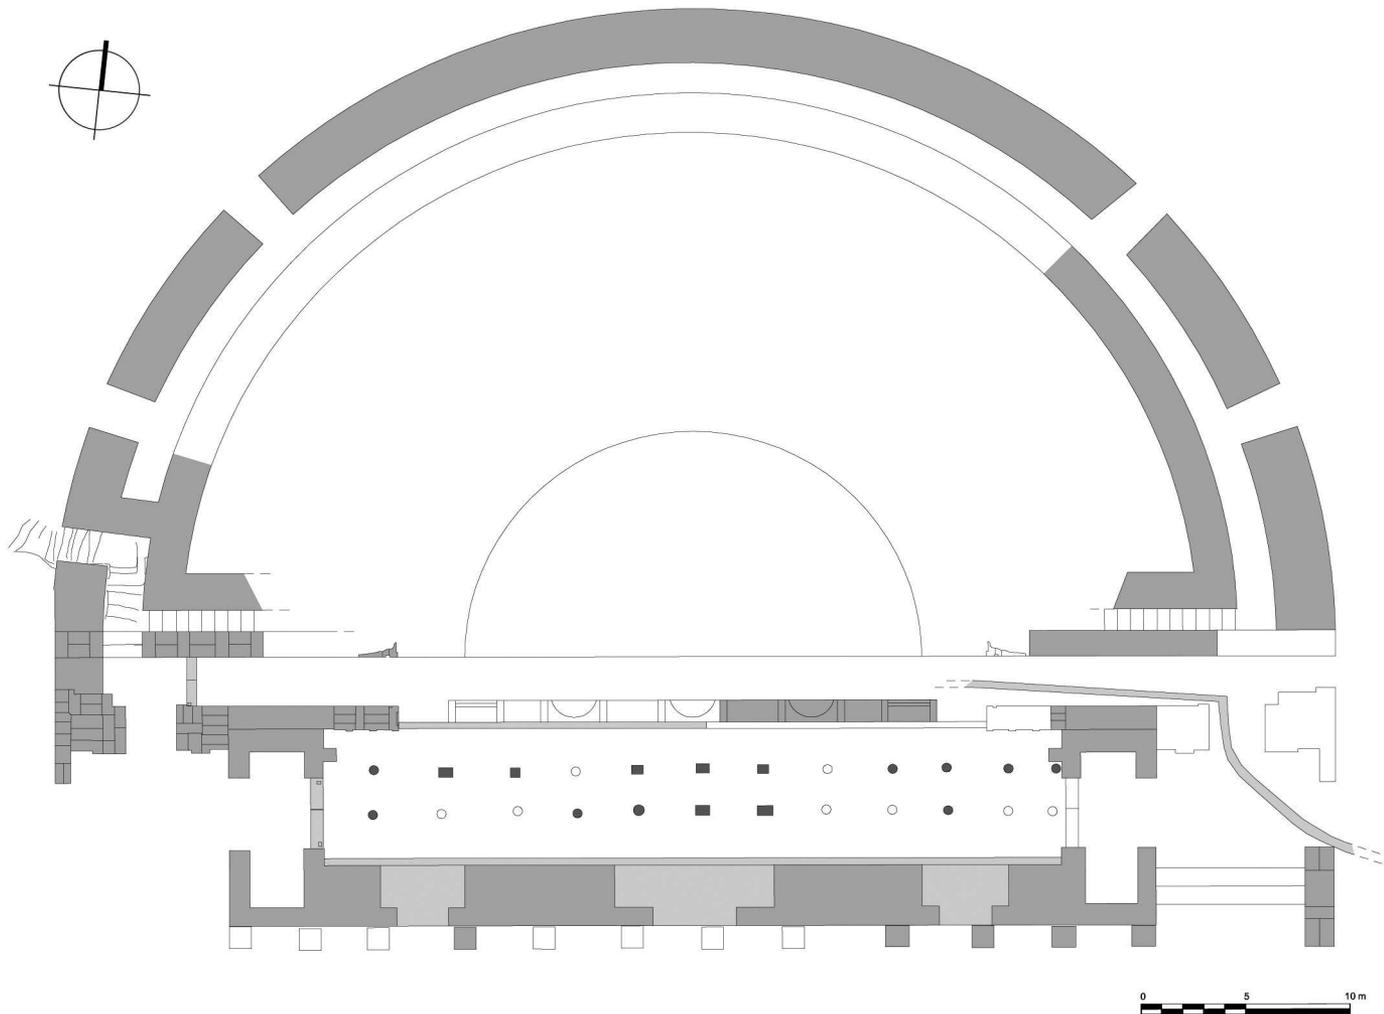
Medellín (Badajoz). Reconstrucción de la planta arquitectónica del teatro romano.
